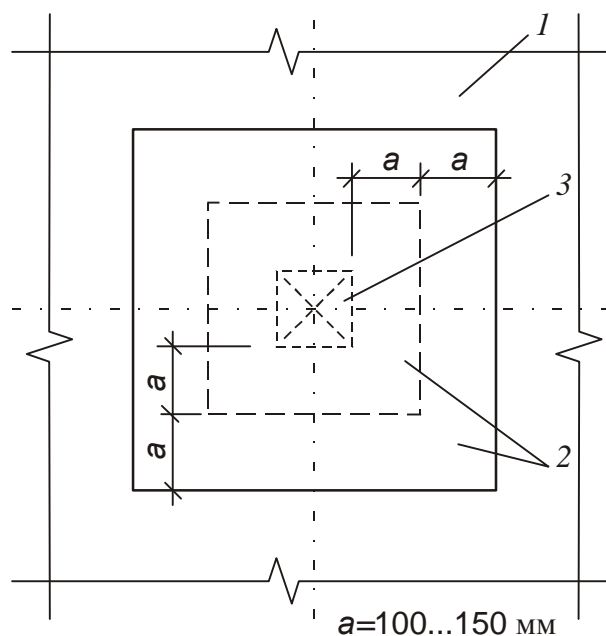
Заплаточный ремонт рулонных кровельных покрытий:
